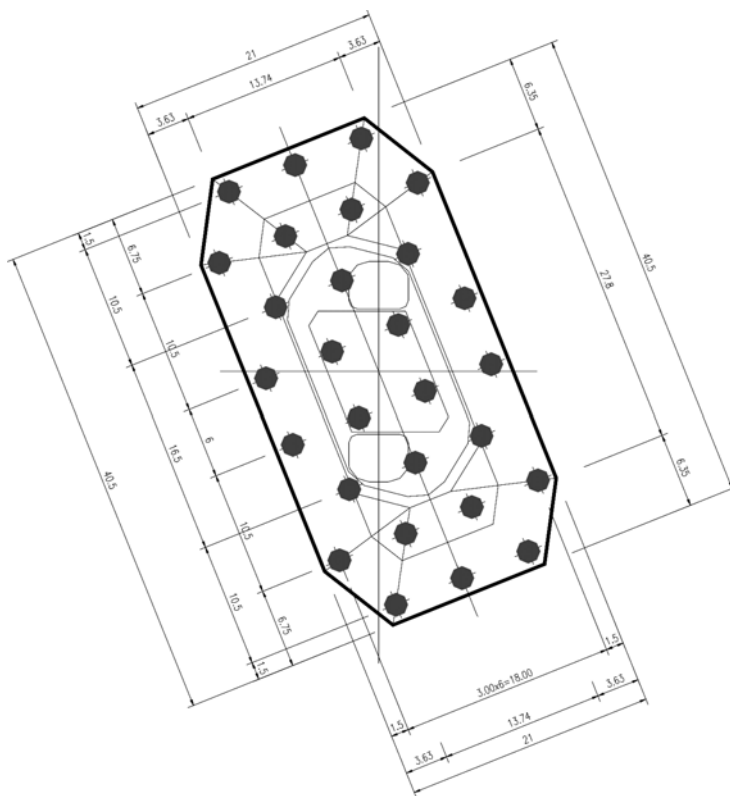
Planimetria della fondazione delle pile 7 e 8 nell'alveo di magra.
